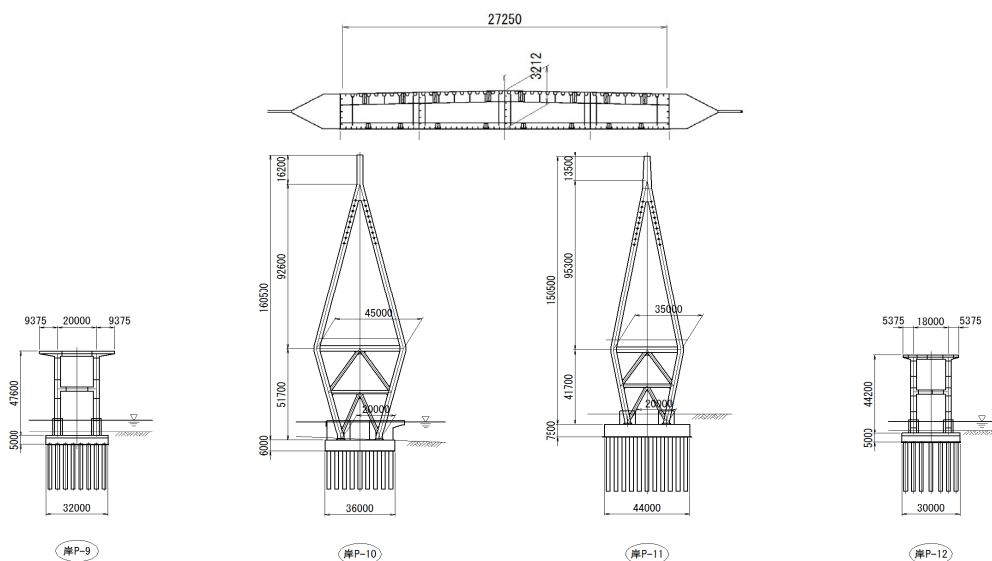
主桁・橋脚・主塔・基礎断面図(unit:mm)
